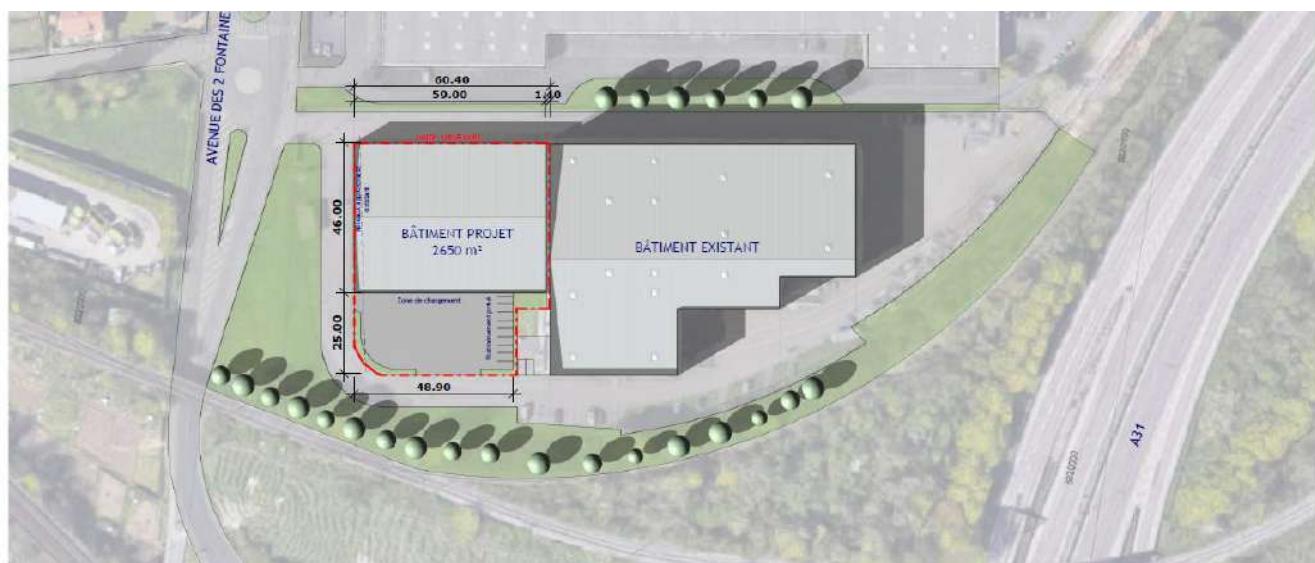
Coupes transversales / Construction bâtiment 2 650m<sup>2</sup>
